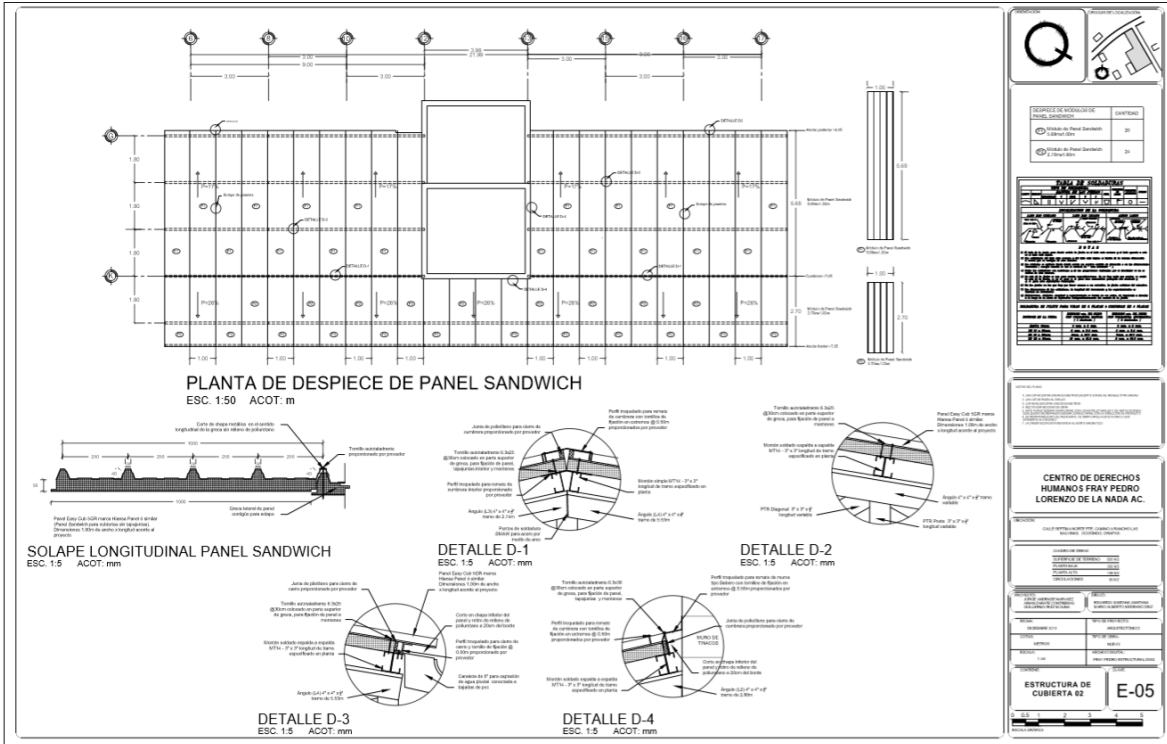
Estructura de cubierta 02. Elaboración propia.
